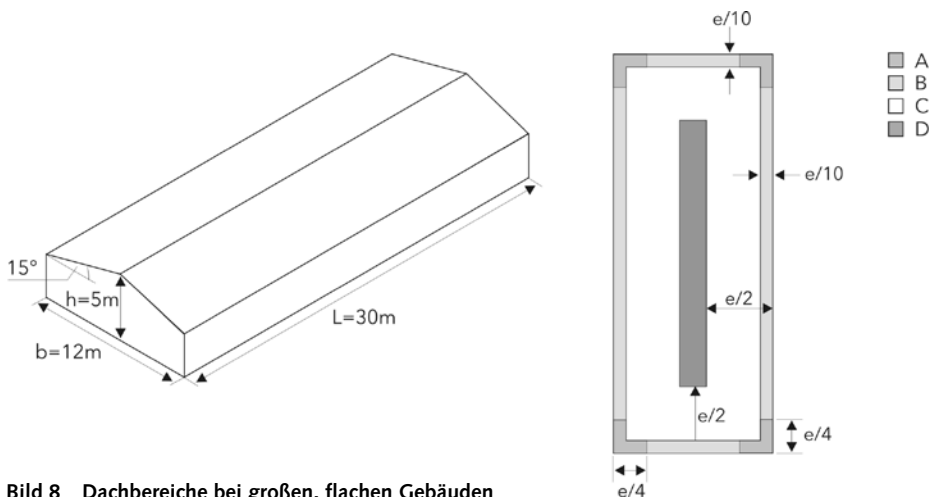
Dachbereiche bei großen, flachen Gebäuden
